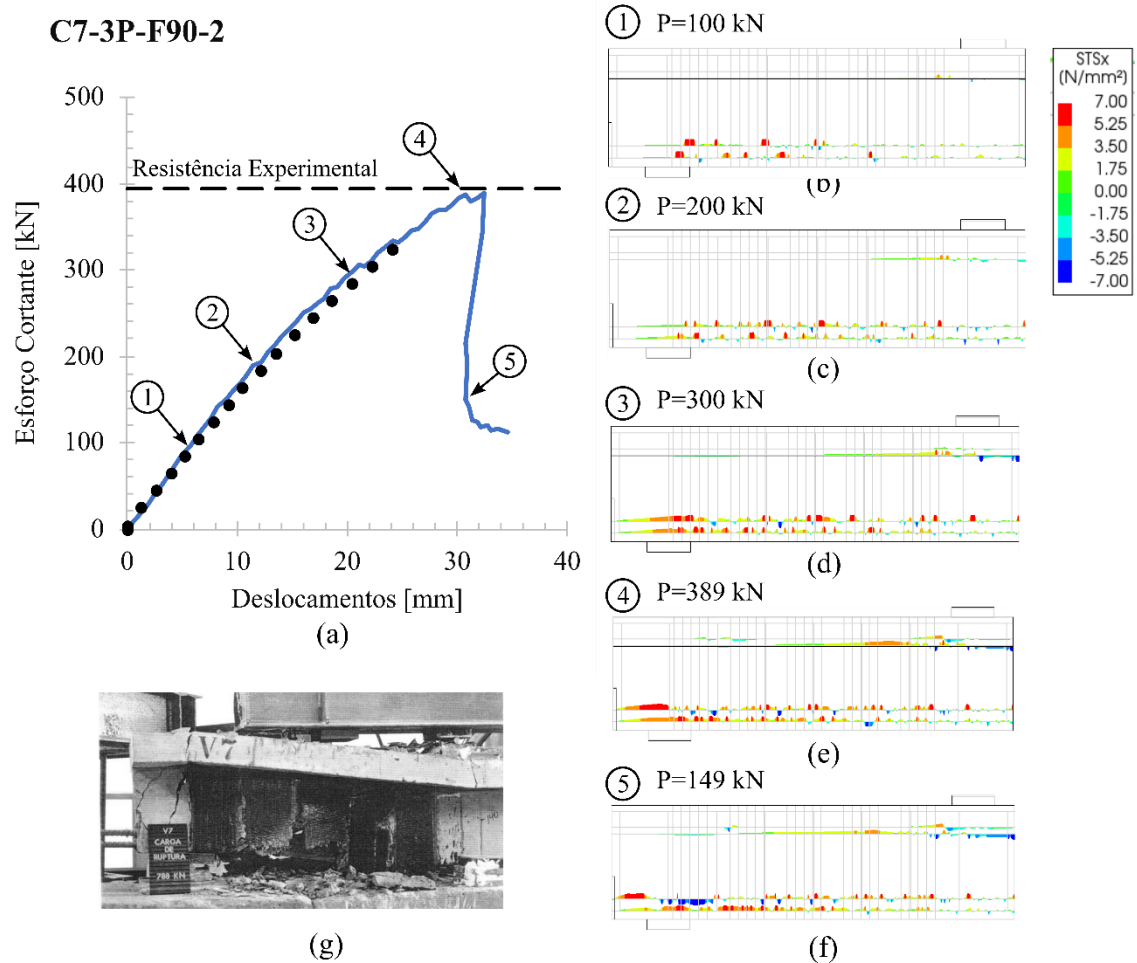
Tensões de aderência entre armaduras longitudinais e concreto para a viga C7-3P-F90-2.
